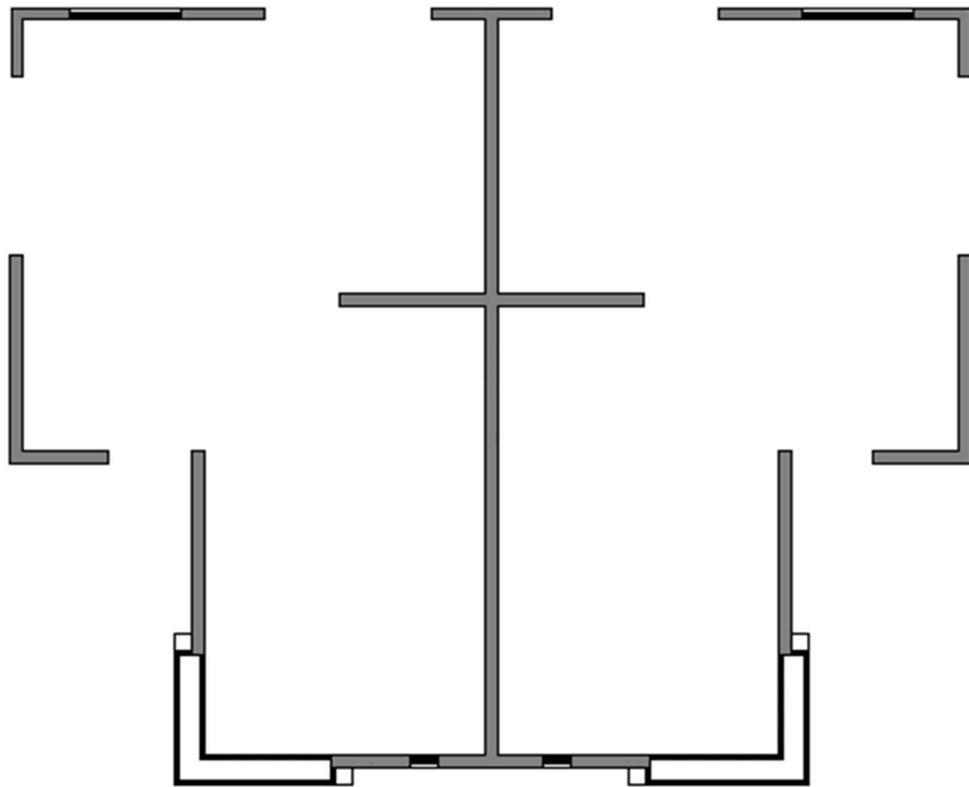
Planta del Primer Piso del Modelo de Casa B1.
